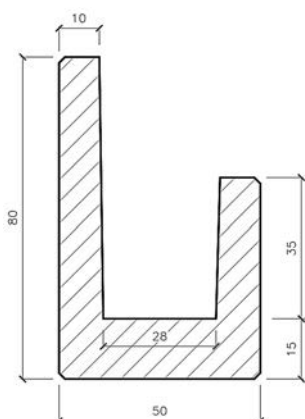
Seção transversal adotada para a viga calha. Fonte: Elaborado pelo Autor
